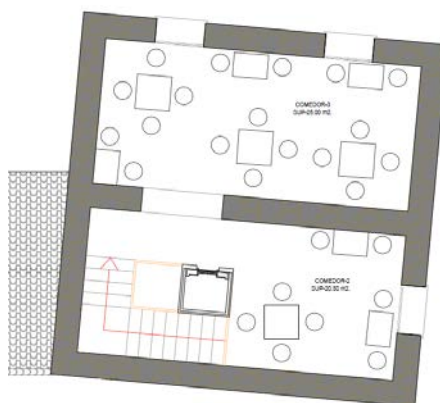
Distribución de las mesas en planta primera. En la imagen, abajo izq. Se observan los dos accesos: por escaleras o bien por el ascensor. (Fuente propia)
